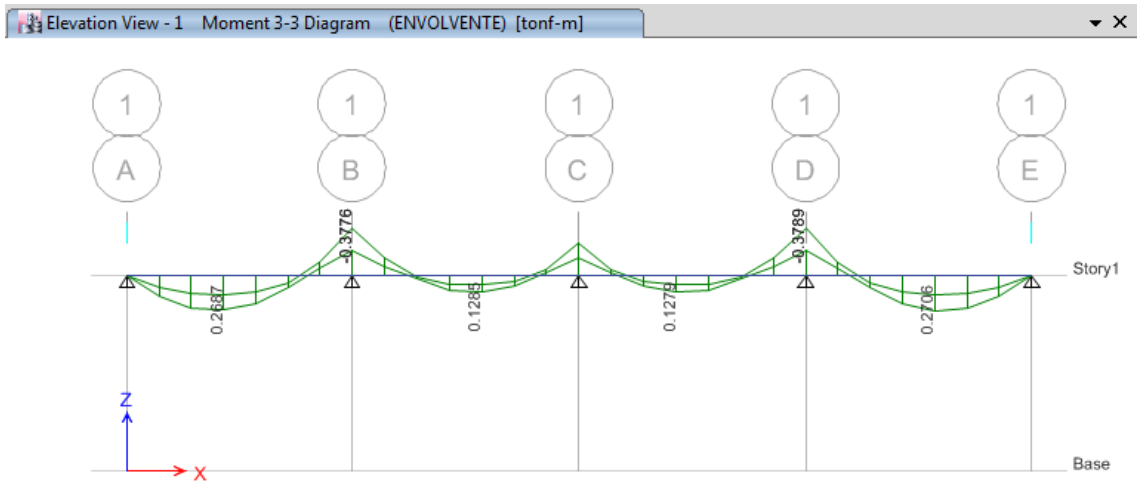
Estado de cargas losa aligerada de Módulo III
